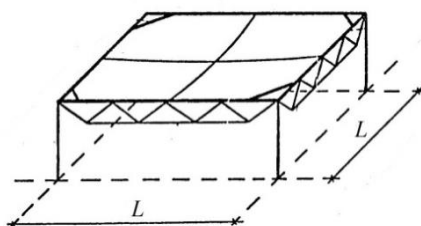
Первоначально плоские многопролетные мембранные покрытия зданий с укрупненной сеткой колонн
